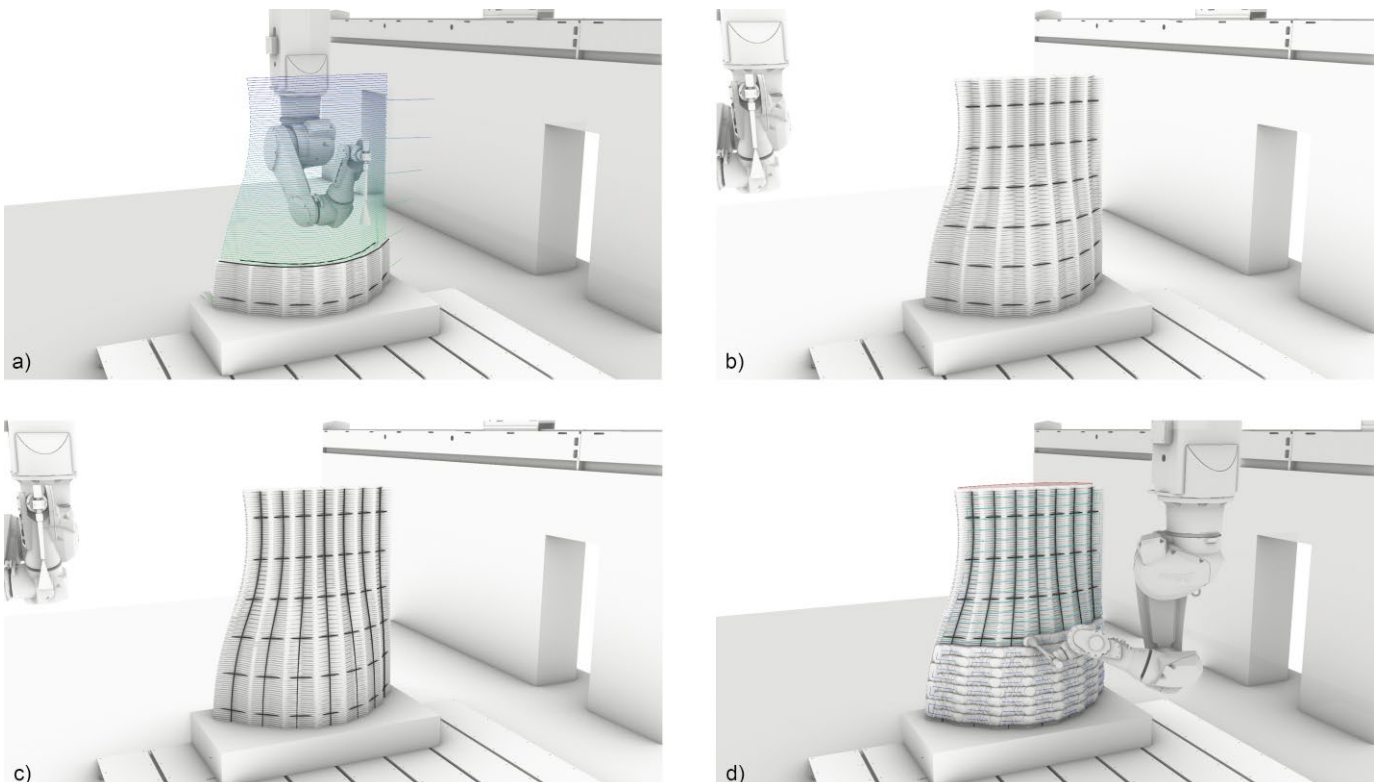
Fertigungsstrategie: a) Drucken der wellenförmigen Bauteilstruktur in horizontalen Schichten und Einlegen der horizontalen Bewehrung in definierten Abschnitten, b) gedrucktes Bauteil mit Taschen zum Einfädeln der vertikalen Bewehrung, c) vertikal eingefädelte Bewehrungsstäbe, d) Aufbringen einer weiteren vertikalen Spritzbetonschicht
